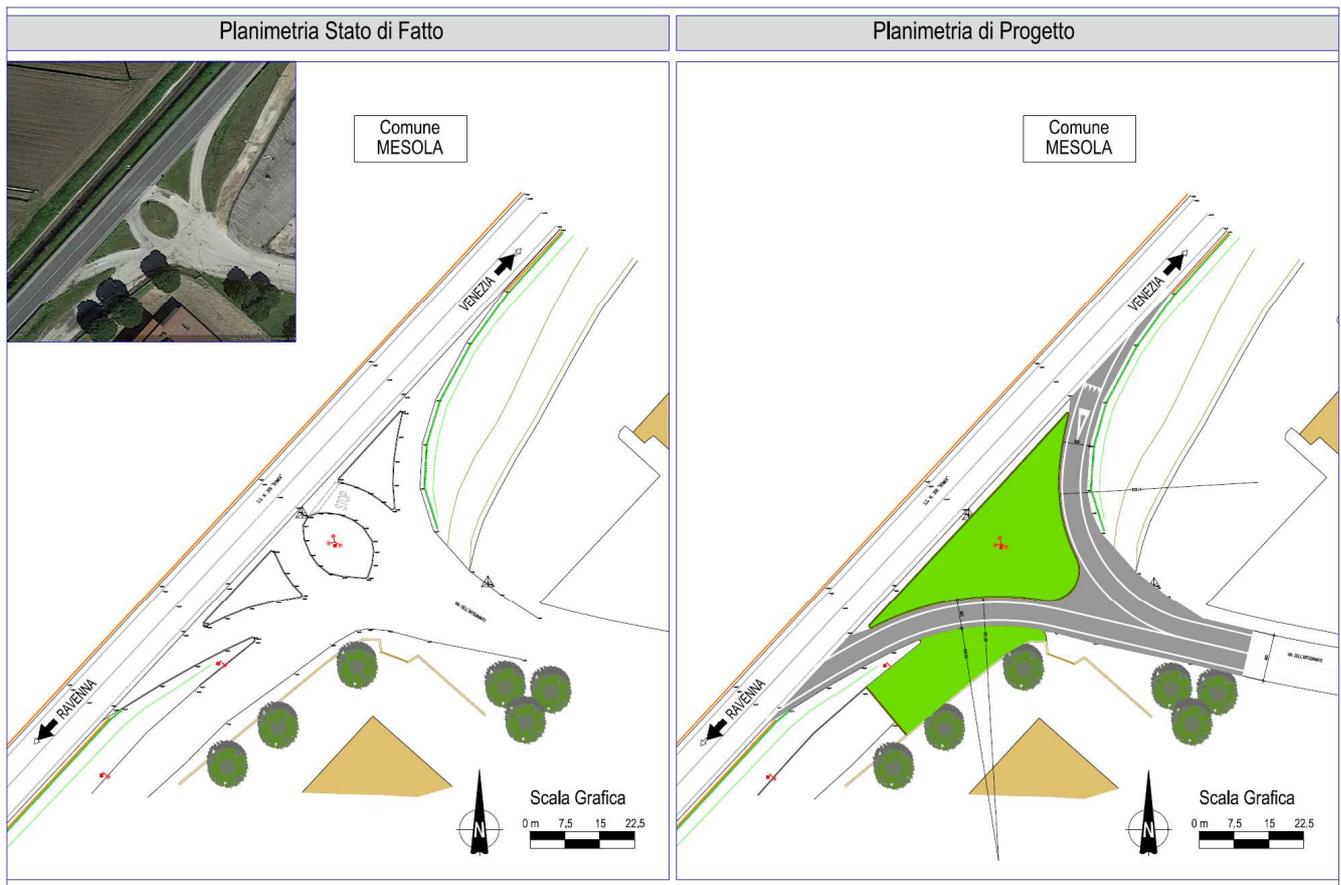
Intervento n°20 – Planimetria Stato di fatto - Progetto
